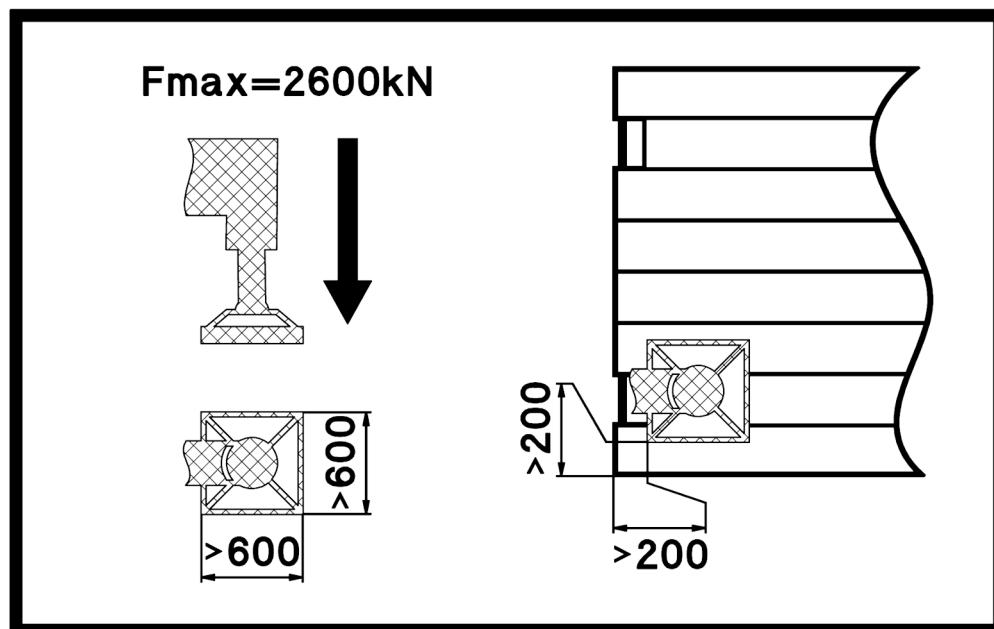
La placa de apoyo se coloca fuera del centro en la plancha de apoyo
